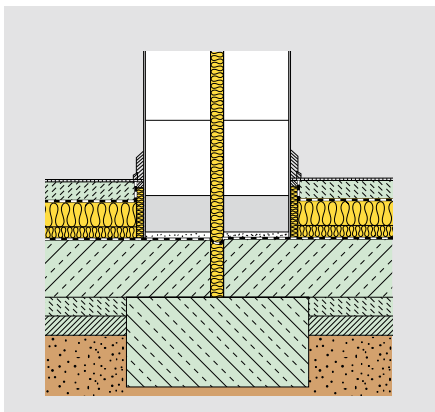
Fundamentanschluss einer zweischaligen Haustrennwand
